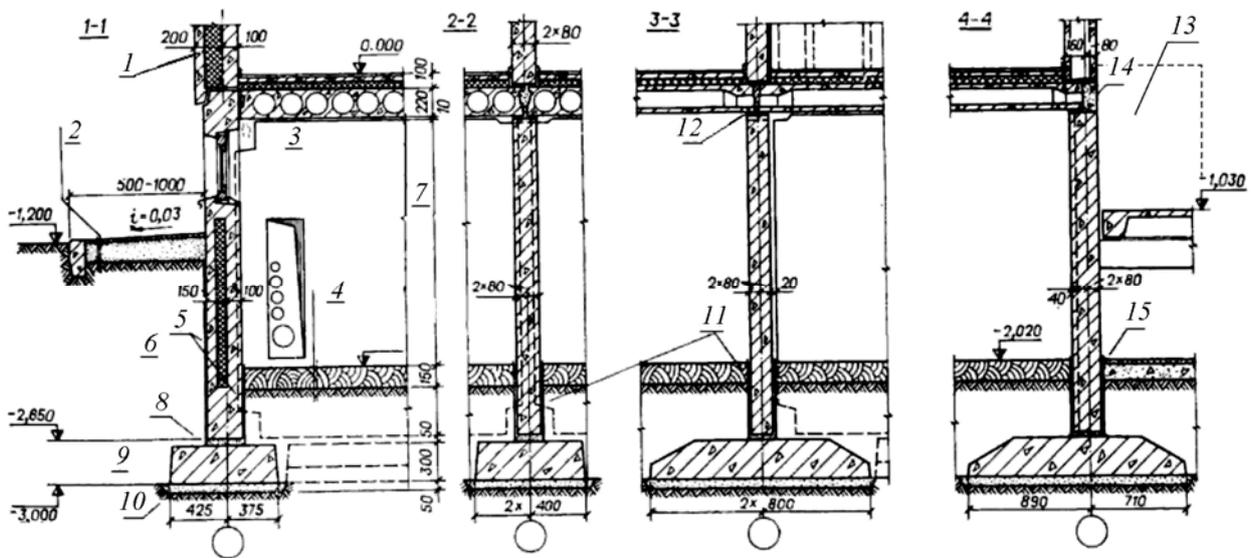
Сечения сборных ленточных панельных фундаментов (при уровне грунтовых вод ниже пола подвала): 1 — панель наружной стены; 2 — асфальт 30, шлак ≥ 150 , уплотненный грунт; 3 — панели внутренних стен подполья, в которых предусматриваются проемы для прохода и проводки инженерных систем; 4 — глинобетон 150, уплотненный грунт; 5 — обмазка горячим битумом (2 раза); 6 — панель наружной цокольной стены; 7 — техническое подполье 1600...1900, подвал ≥ 1900 ; 8 — цементный раствор, состав 1 : 2; 9 — фундаментные плиты на песчаную подушку 50; 10 — подошва фундамента; 11, 15 — обмазочная гидроизоляция; 12 — противокapиллярная гидроизоляция, цементный раствор с водостойкими добавками; 13 — пространство лестничной клетки; 14 — подбетонка по месту
